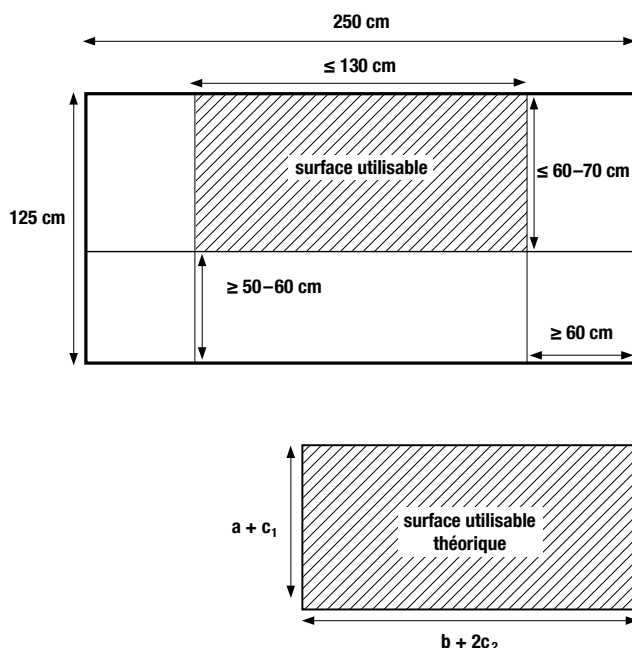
Dimensions d'un panneau de bois standard et surface utilisable pour barrer une rigole; pour la définition de a , b et c , se référer à la fig. 65, page 53
